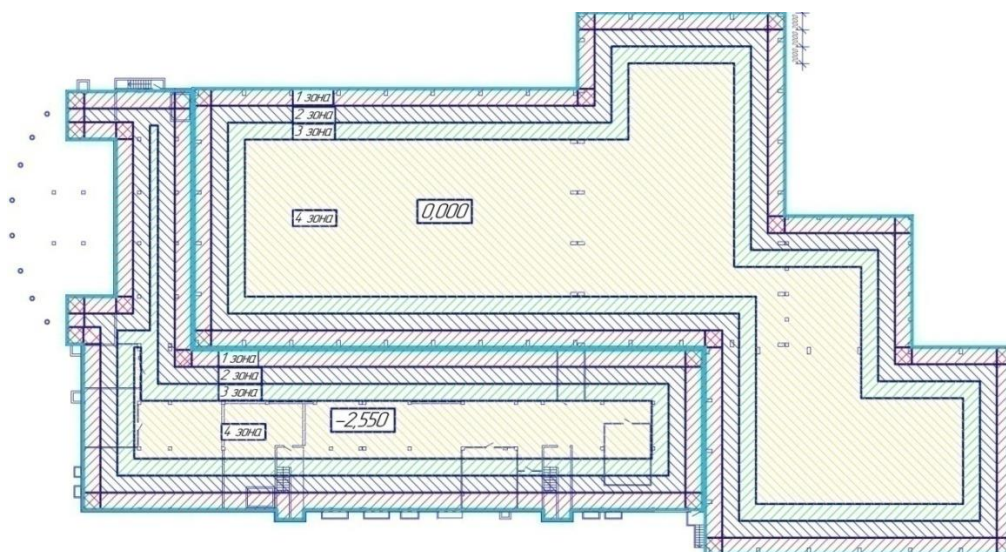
План здания с разбивкой на зоны для теплотехнического расчёта
